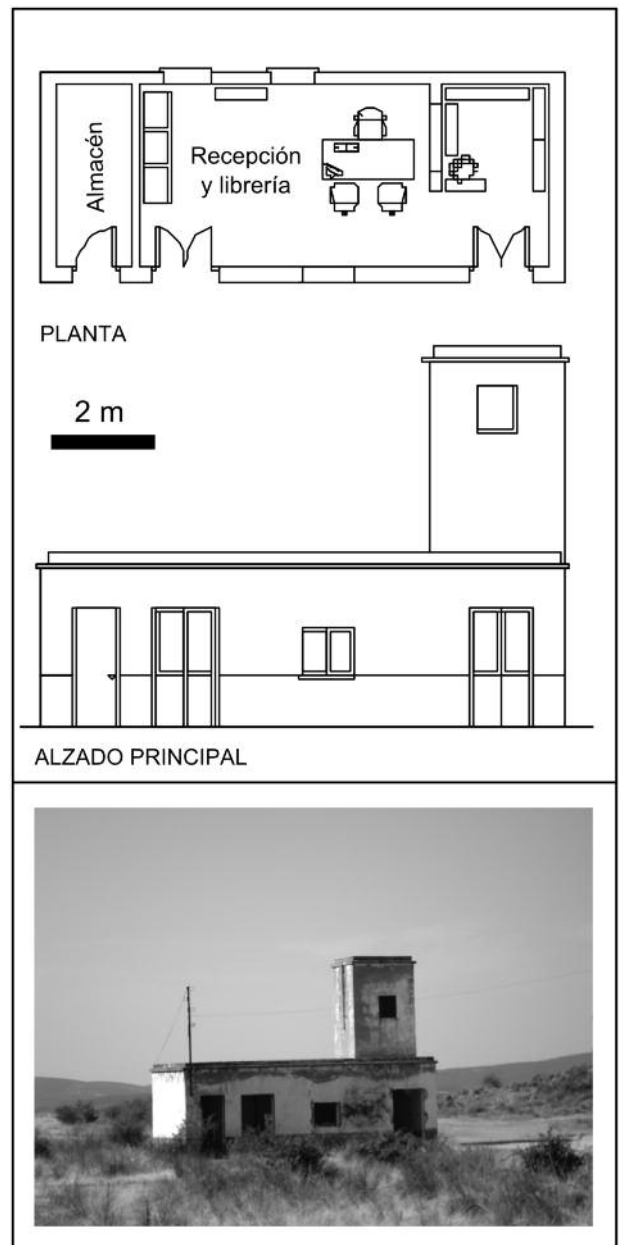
Planta y alzado del edificio del transformador eléctrico tras su recuperación como centro de visitantes. Debajo, fotografía de su estado actual.
